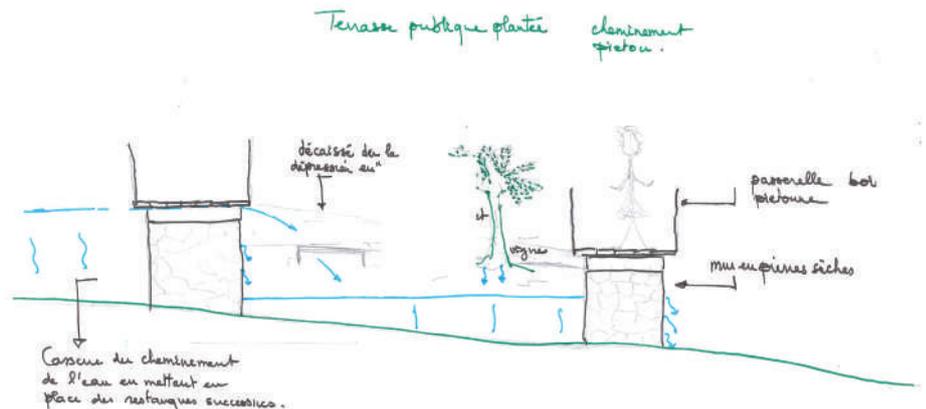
Coupe transversale proposée par le 1er groupe «d'architectes paysagistes» sur Coudoux
